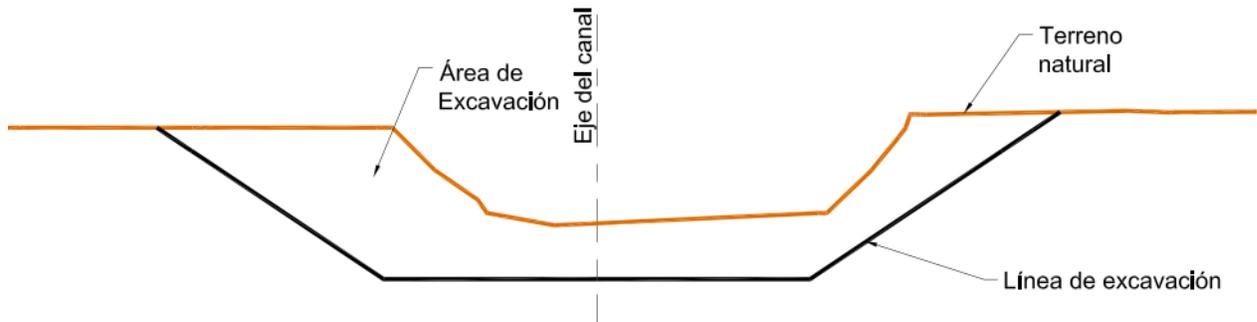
Sección tipo del canal de descarga 0+200 a 0+340
